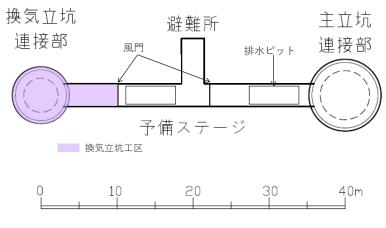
深度100m水平坑道換気立坑工区平面図
